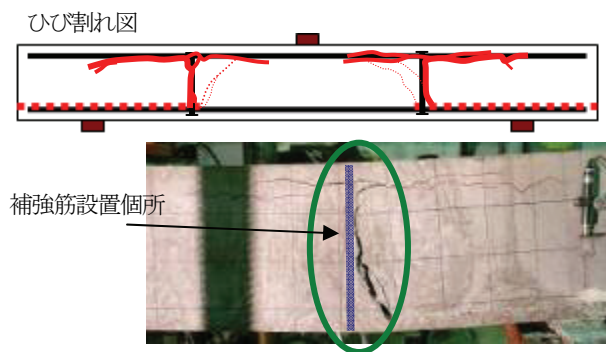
補強試験体2-荷重試験 ひび割れ状況
